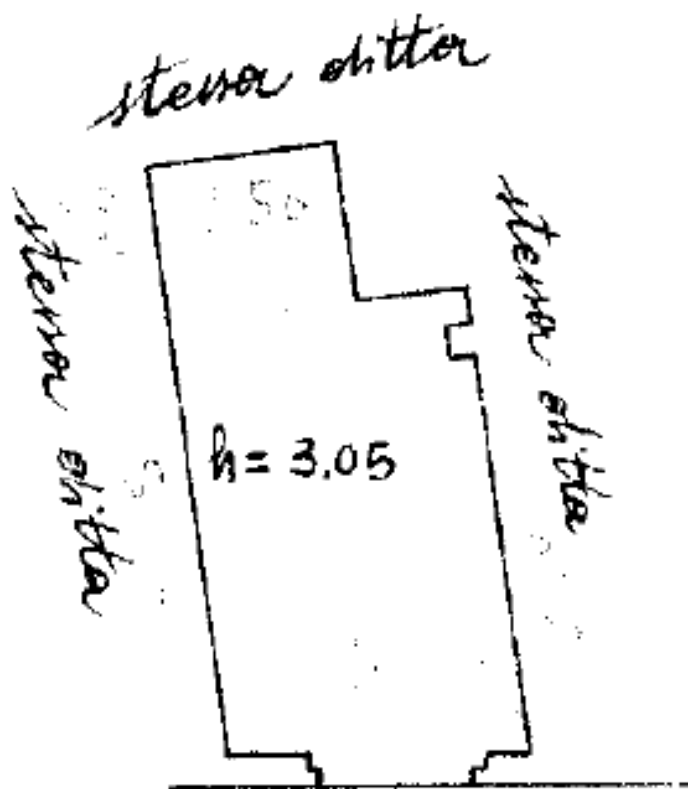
planimetria catastale in atti abbinata al sub 13 della p.la 4973 F.29
